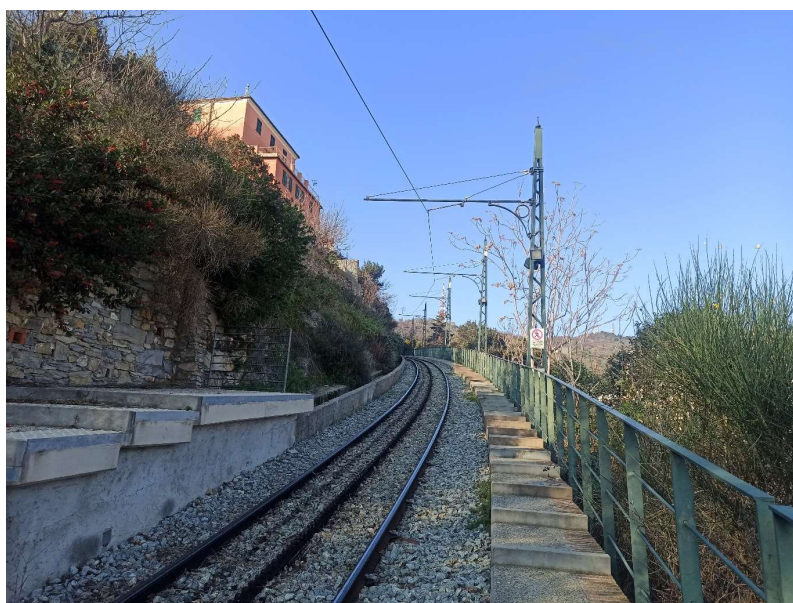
Aspetto finale con i tralicci esterni al camminamento, in un tratto già interessato dall'ammodernamento
